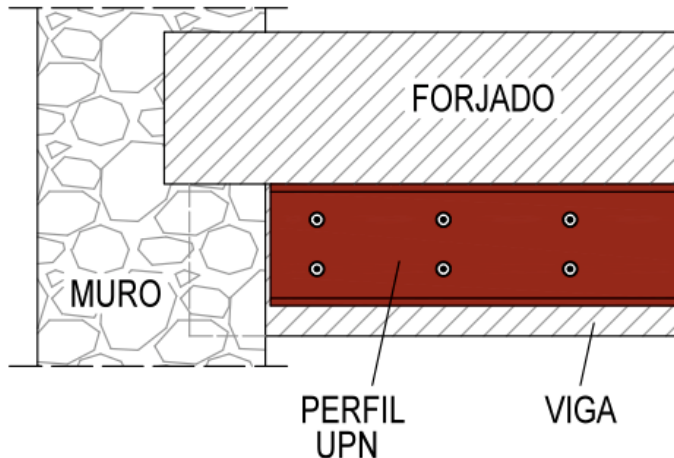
Sección refuerzo de viga mediante perfiles UPN. Fuente propia.
